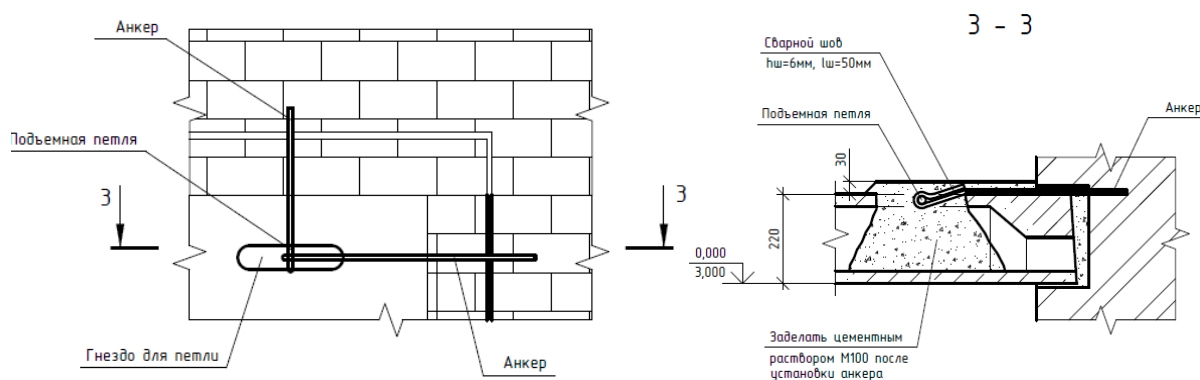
Стяжка плит перекрытия и покрытия анкерами с продольными и поперечными стенами
